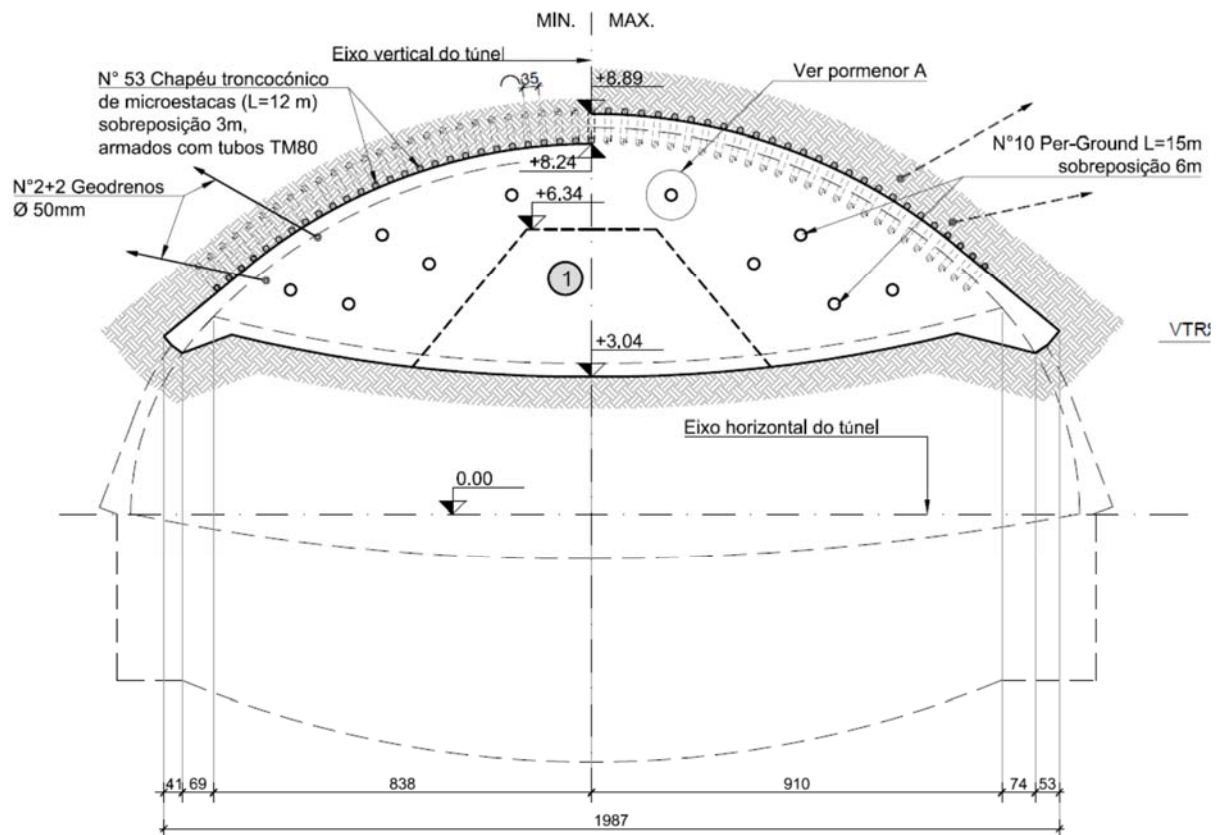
Seção tipo da fase 1 – pré-suporte da calote superior - escavação e suporte primário em ZG3
